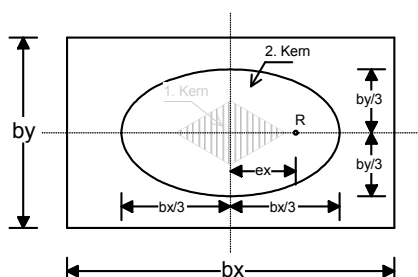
Grundriss eines rechteckigen Fundamentes; Begrenzung der 2. Kernweite
